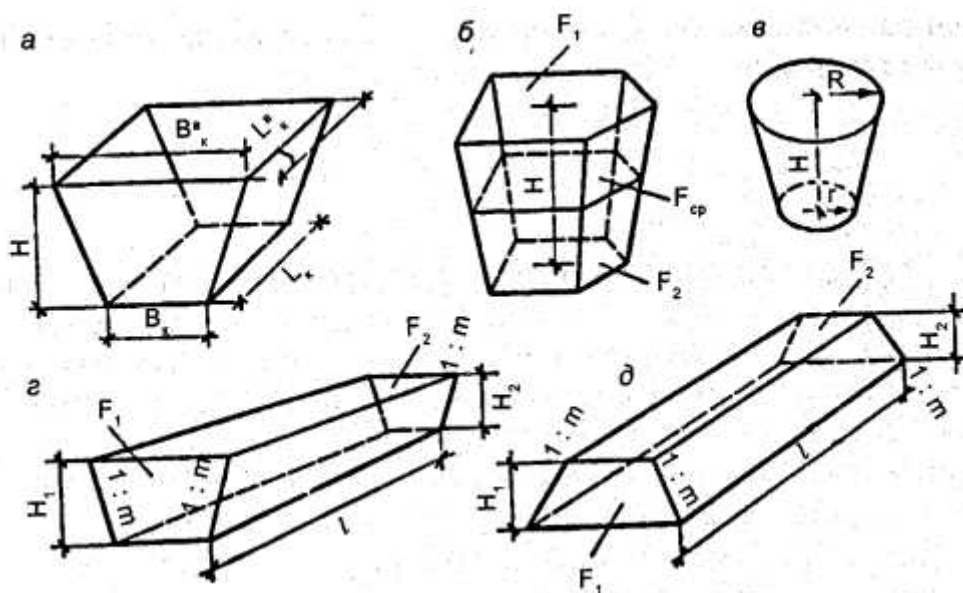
Схемы для определения объёмов земляных работ при устройстве котлованов различной формы, траншей, насыпей: а, б, в - котлованы прямоугольные, многоугольные, круглые; г - траншея с откосами; д - насыпь
